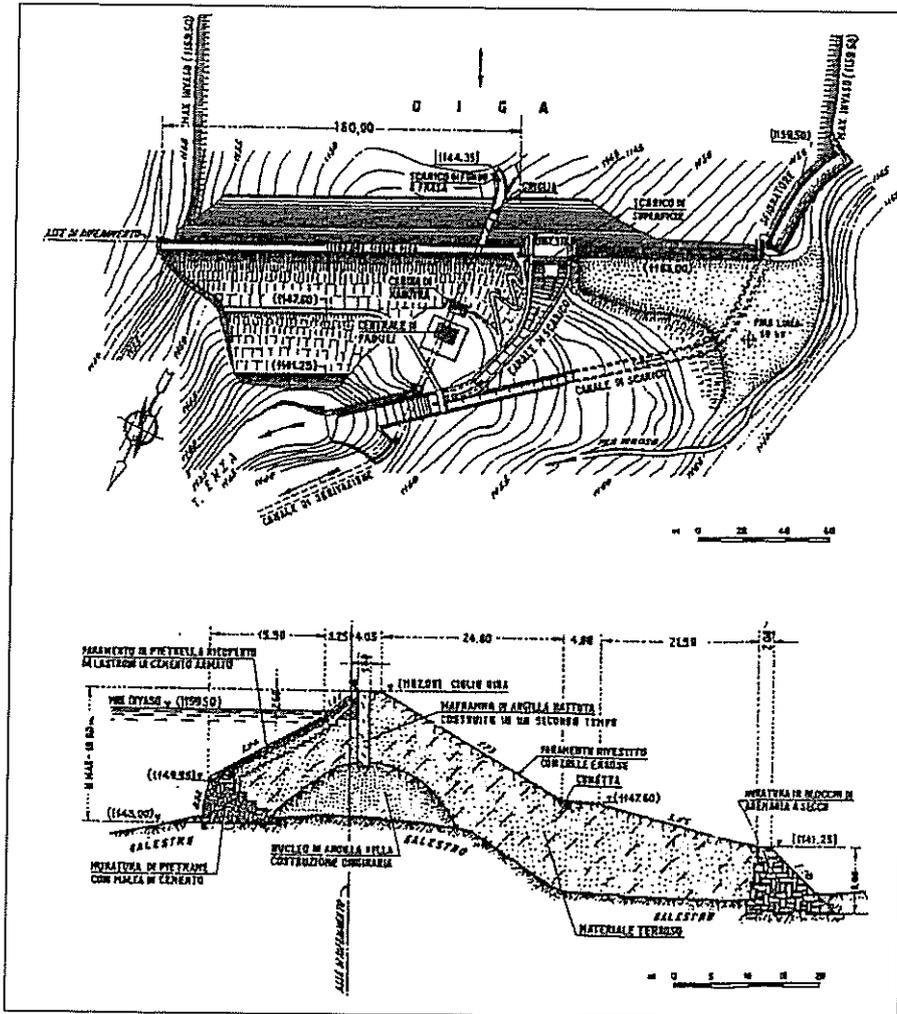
Diga di Paduli: Planimetria - Sezione tipo.
